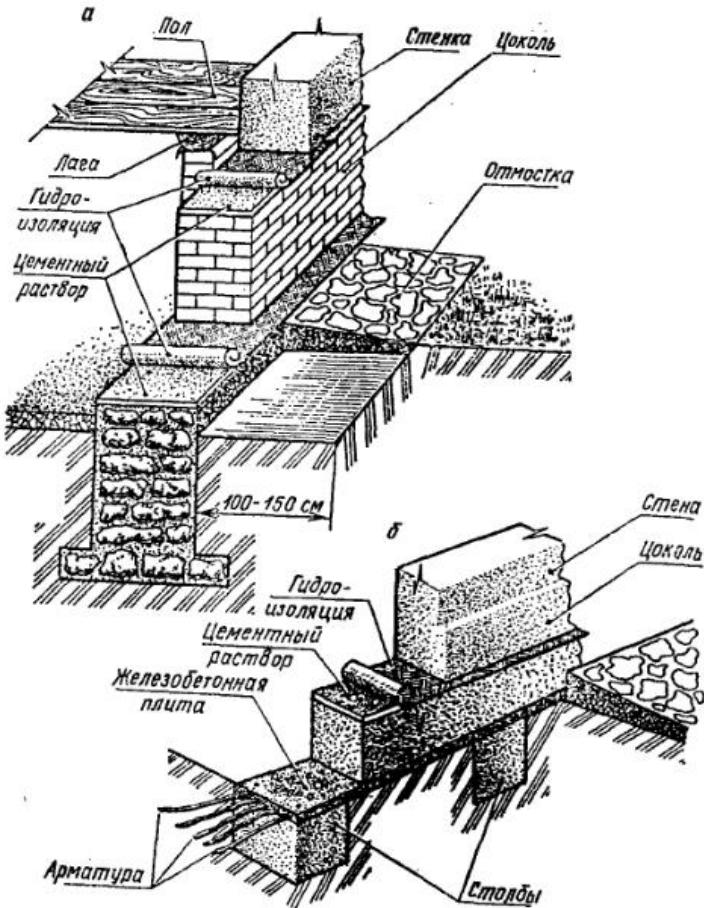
Фундаменты: а — ленточный; б — столбчатый.
